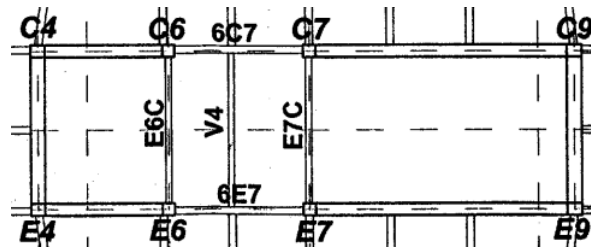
Vista en planta de los muros en forma C para el ascensor y las escaleras
